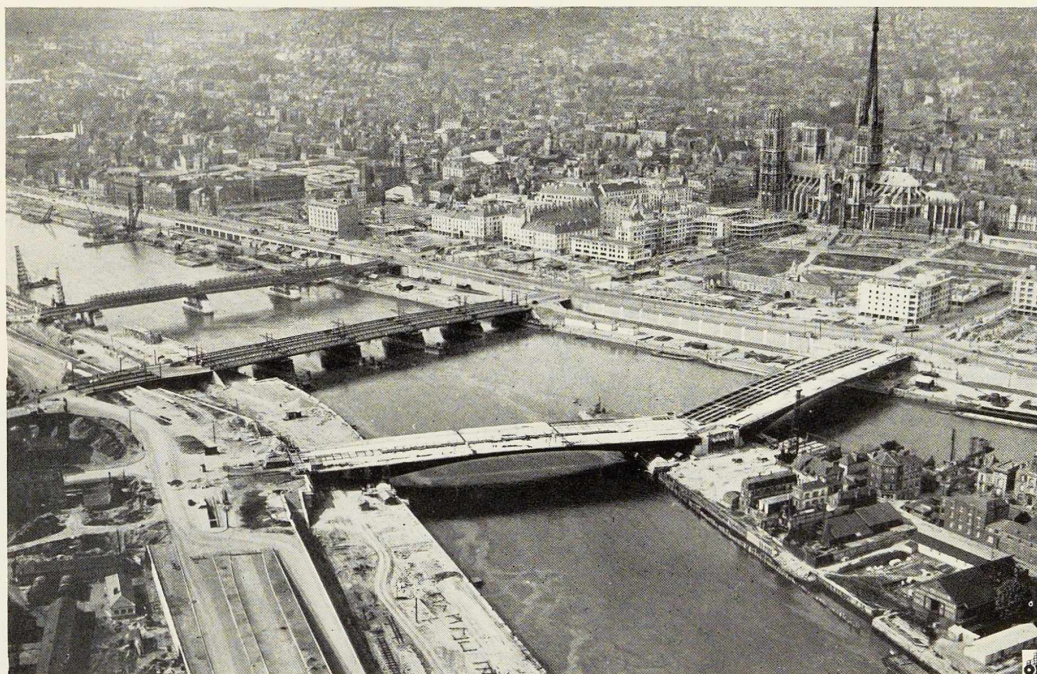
Vue aérienne de la ville de Rouen. Au premier plan l'île Lacroix et le pont Cornaille. Au second plan deux ponts provisoires sur la Seine.
